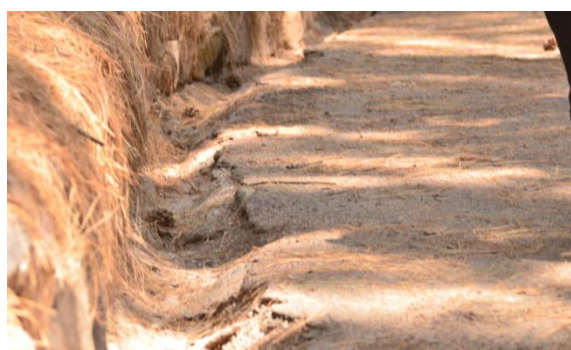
Detalle de acequias de drenaje pluvial en senderos
